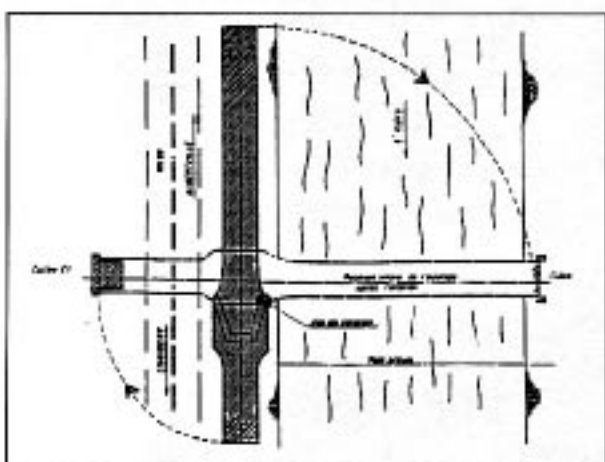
Construction de l'ouvrage sur la rive, parallèlement à l'Isère, puis mise en place par rotation.
